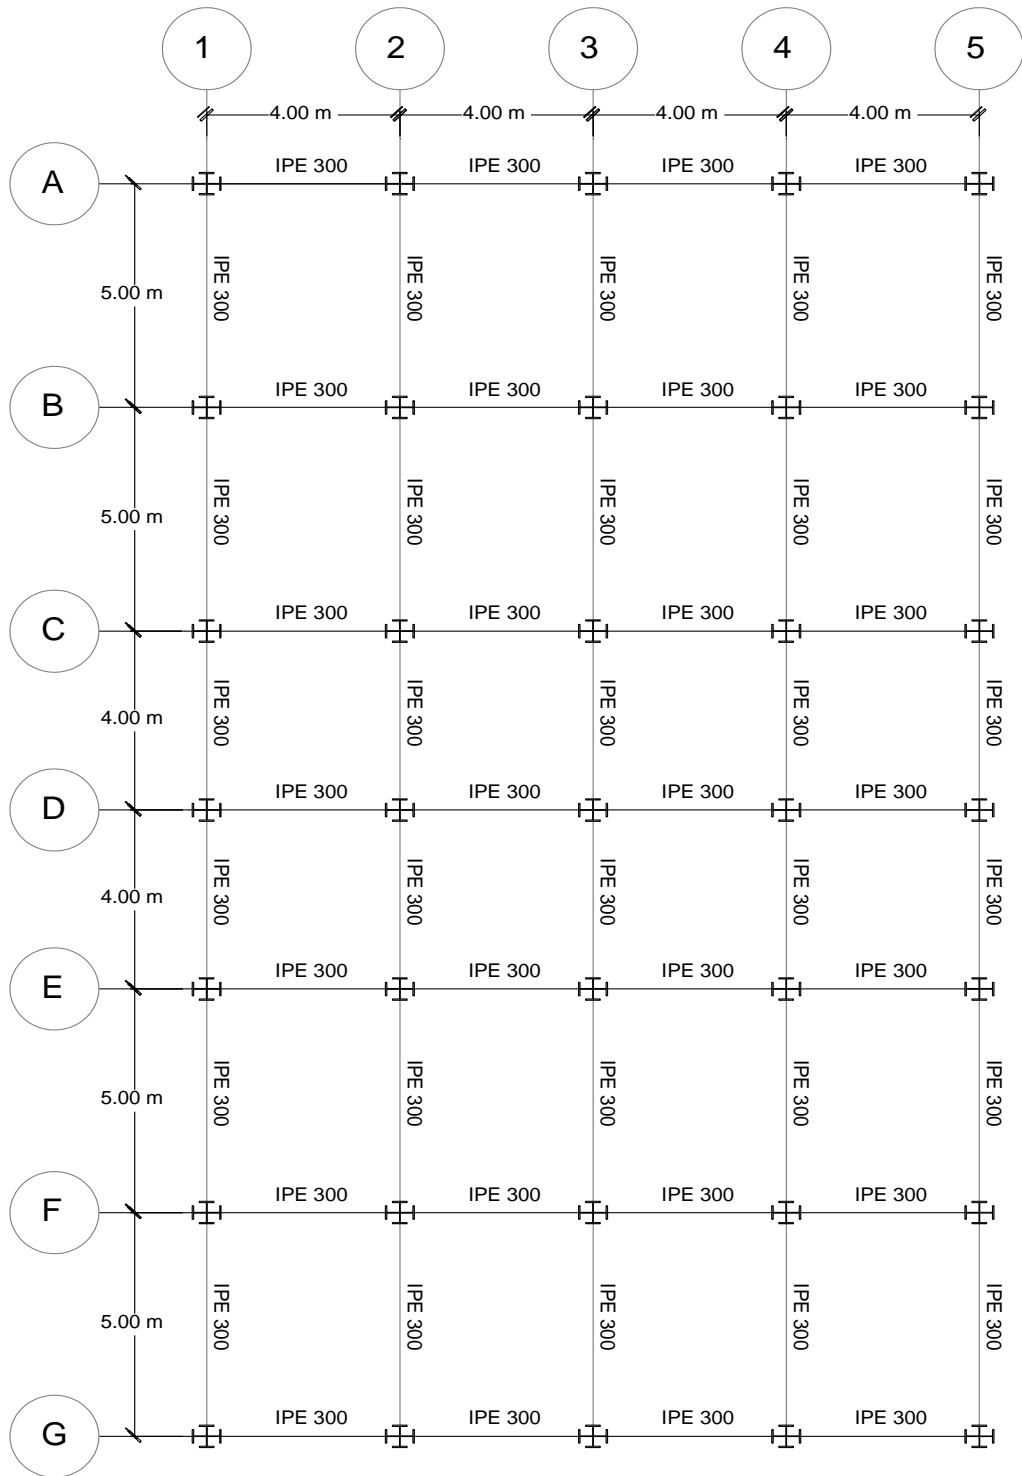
Secciones utilizadas vista en planta piso 6.
